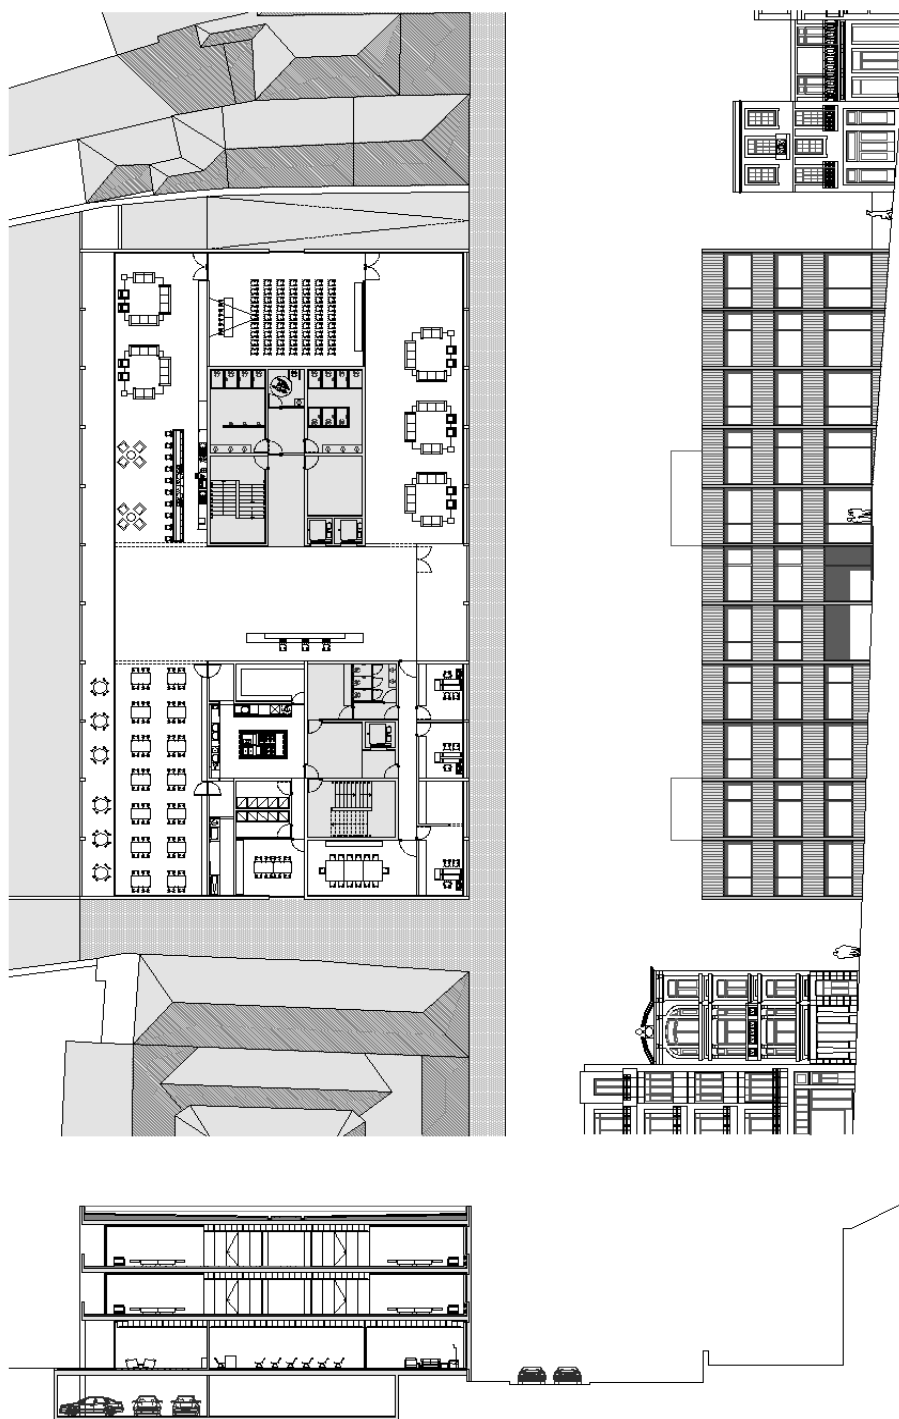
Planta do piso térreo com correspondência do alçado e corte transversal
